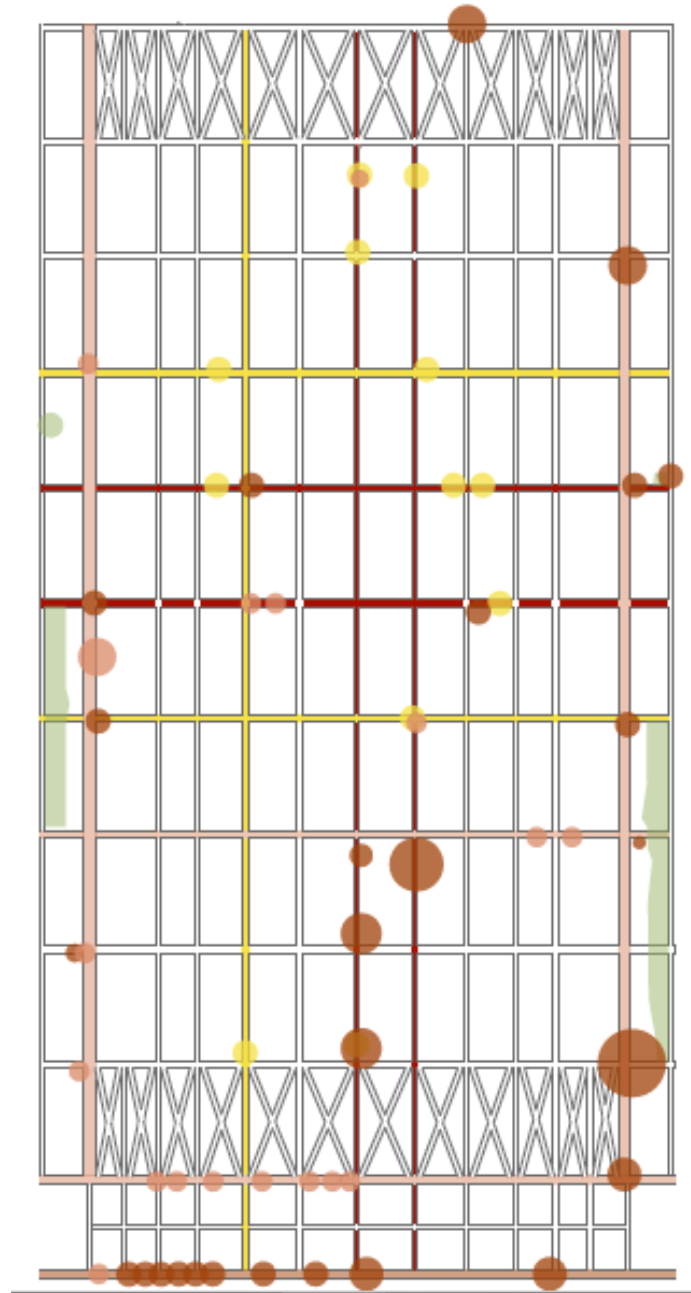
Planta esquemática de humedad en zonas de la nave central del mercado. (elaboración propia)
